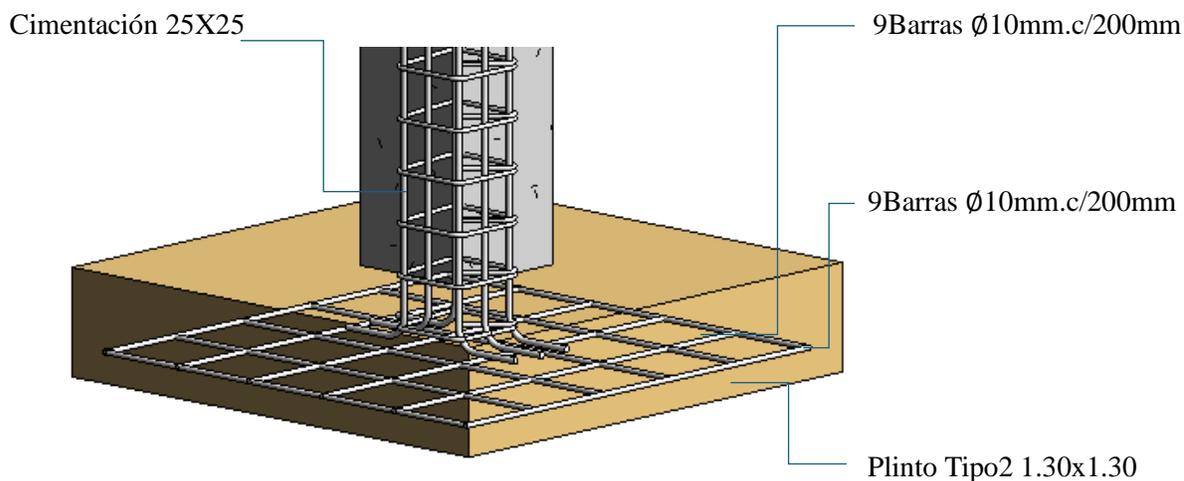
Zapata aislada tipo 3 modelado en Revit. (Inmovila 2023)
